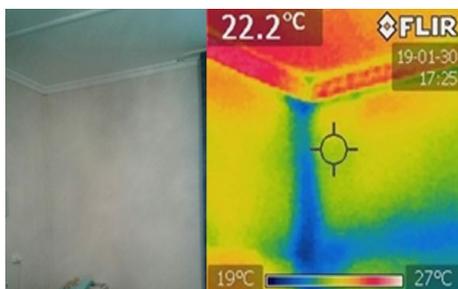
Термограмма стыка наружной стены и межэтажного перекрытия панельного дома
